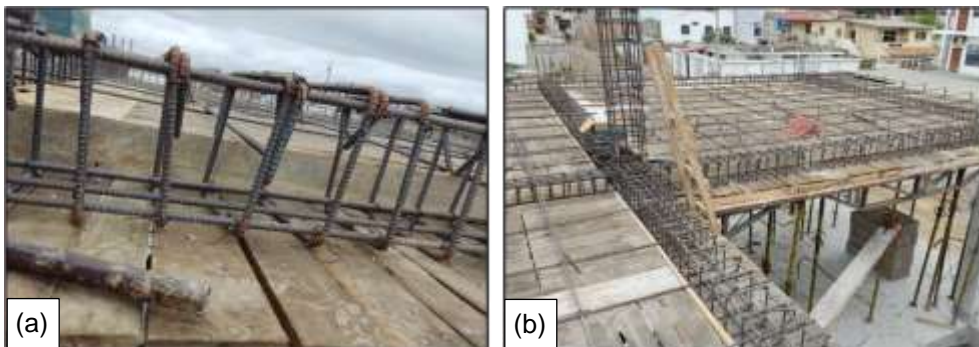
(a) y (b) Recubrimiento insuficiente de las barras de acero en vigas y losa.
